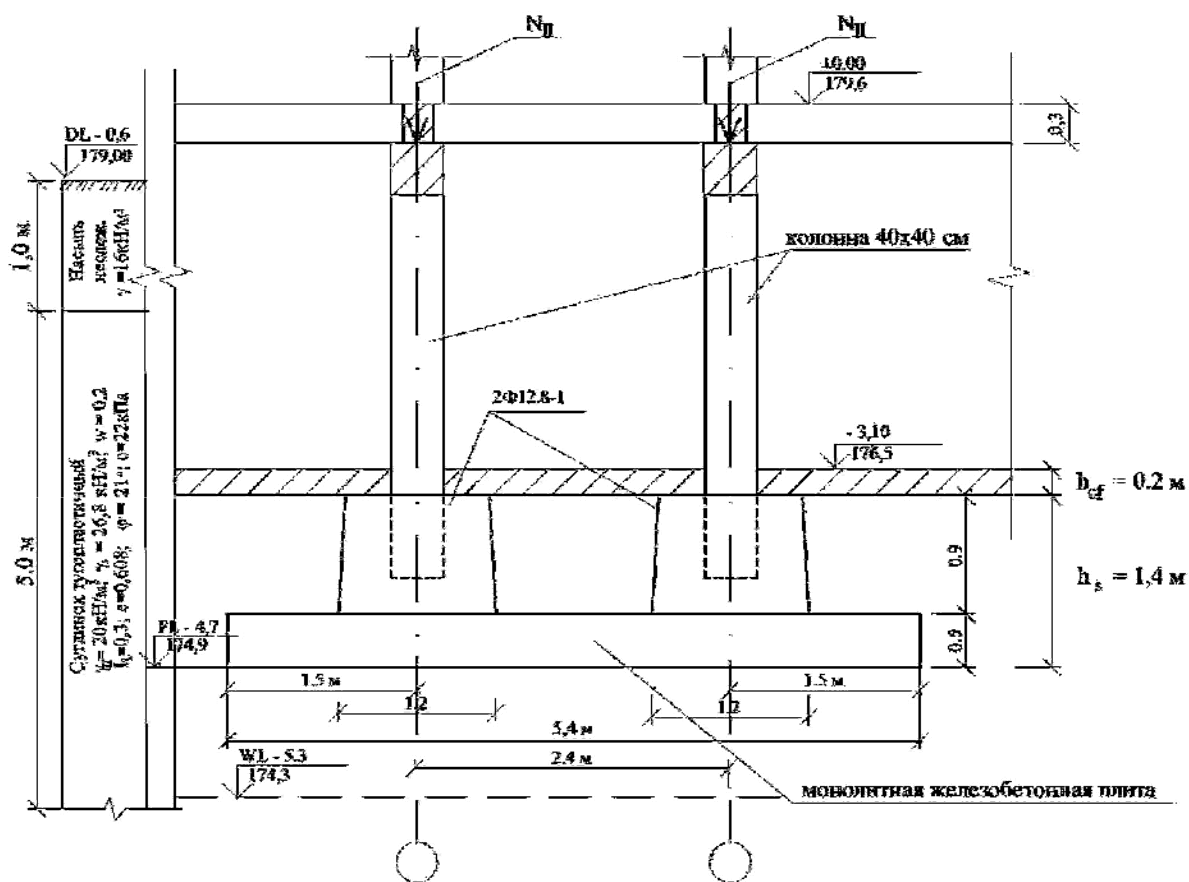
Схематичный разрез фундамента под две внутренние колонны каркасного здания.
